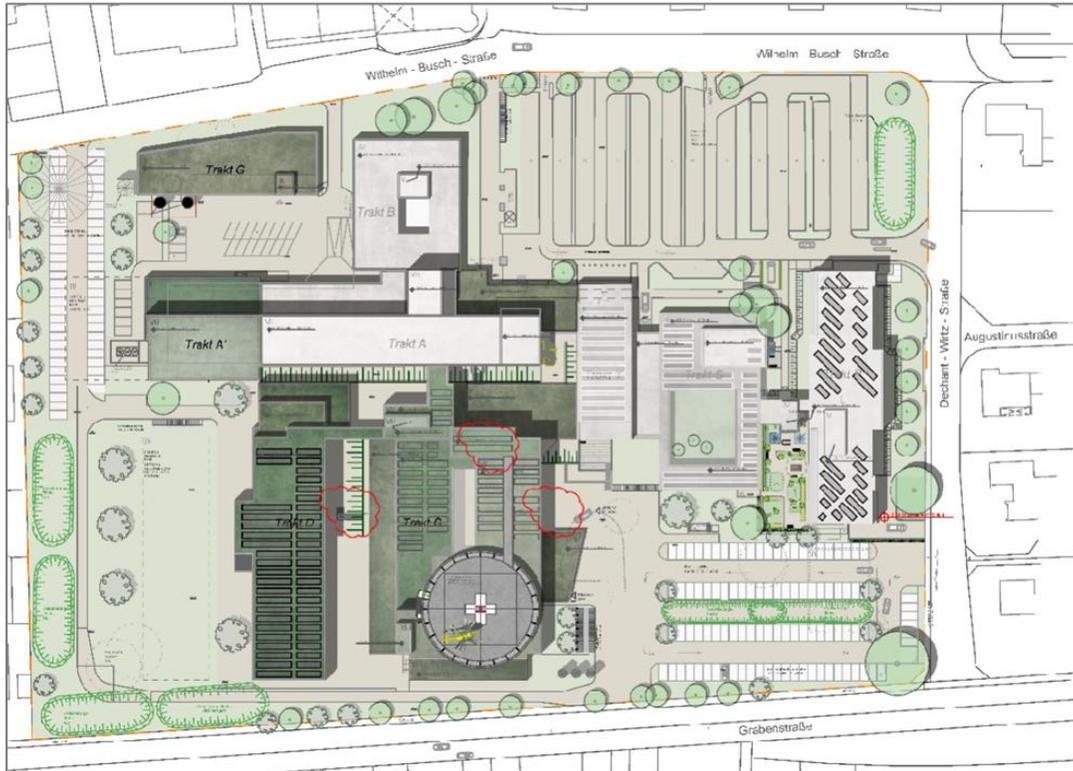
Lageplan des Bauvorhabens (Quelle: Architekten Beckmann)
